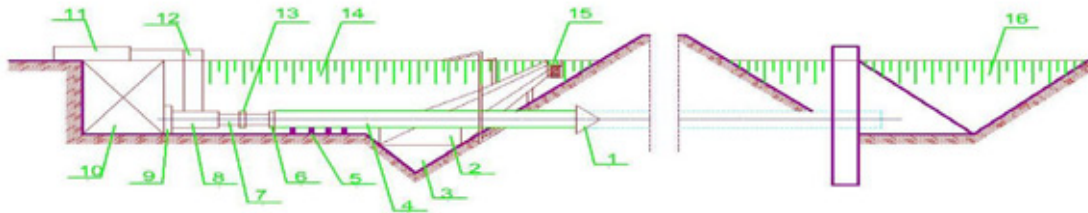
Установки для прокладки труб методом продавливания: с ручной разработкой грунта. 1 – насосная станция; 2 – трубопровод; 3 – рабочий котлован; 4 – водоотводный поток; 5 – трубопровод (футляр); 6 – лобовая обделка (нож); 7 – приемный котлован; 8 – приямок для сварки труб; 9 – направляющая рама; 10 – нажимной патрубок; 11 – нажимная заглушка; 12 – гидродомкрат; 13 – башмак; 14 – упорная стенка; 15, 18 – канаты; 16 – ролики.
